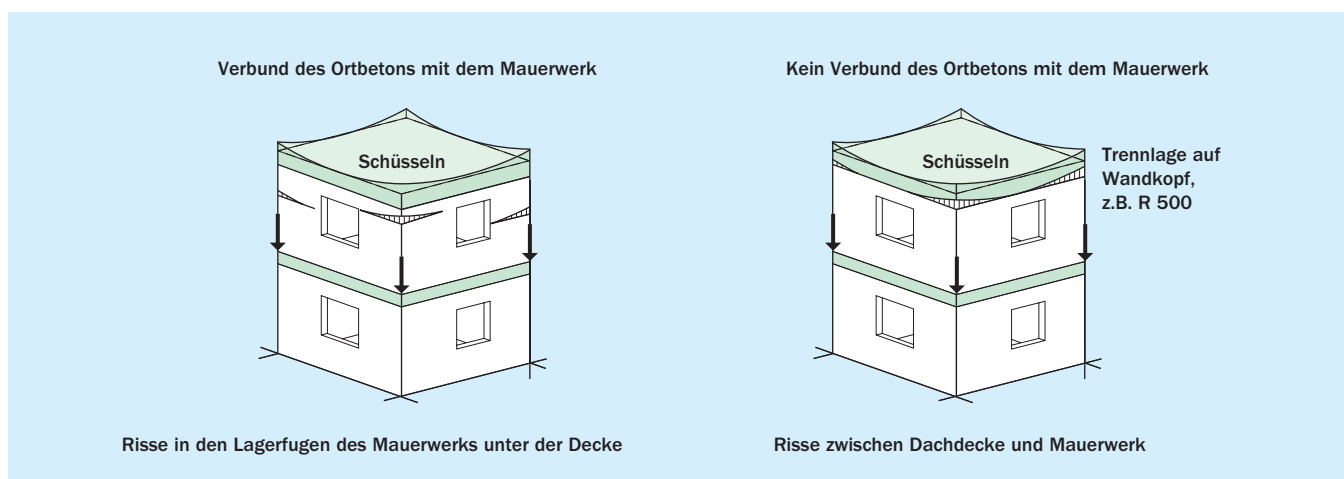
Eckabhebung der Dachdecke – Risse im Mauerwerk und zwischen Mauerwerk und Decke
